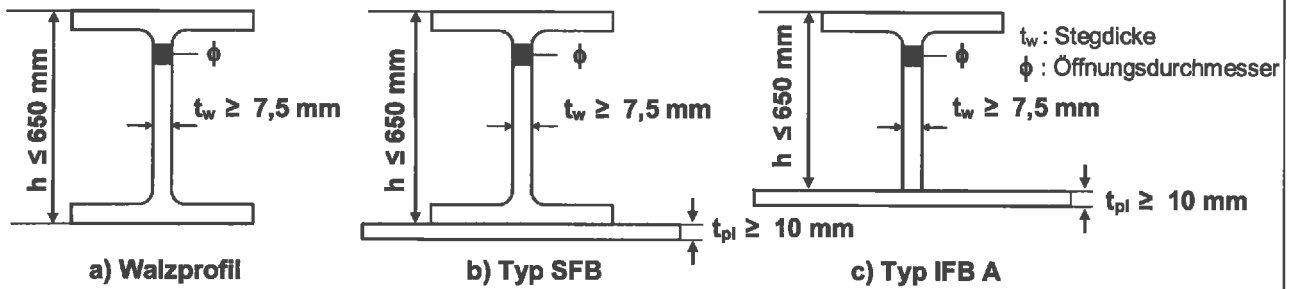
Zulässige Querschnittsformen der Stahlträger
